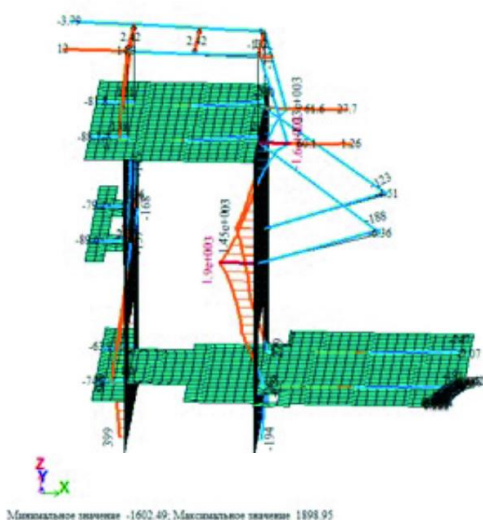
Эпюры продольных сил в сжатых и растянутых элементах стальных ферм, а также поперечных сил в монолитных колоннах в зоне опирания стальных ферм на монолитные конструкции
